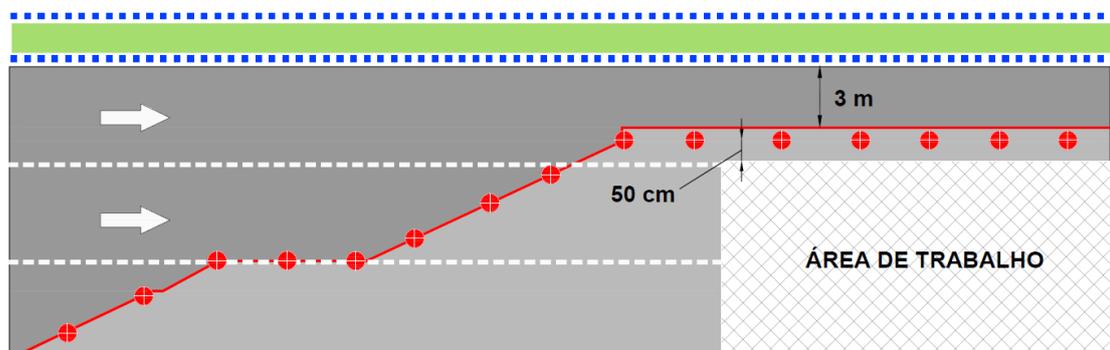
Posicionamento de dispositivos de canalização – Pista com 3 Faixas (caso 1)
